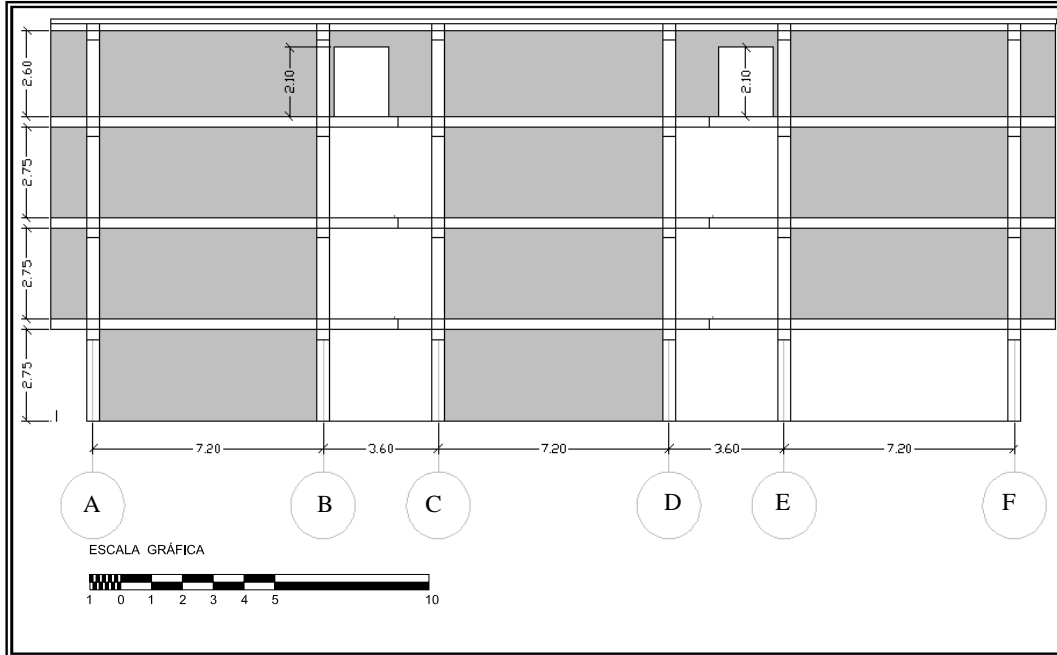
Pórtico 2 (norte-sur) mostrando las paredes de mampostería y la longitud efectiva de columnas
